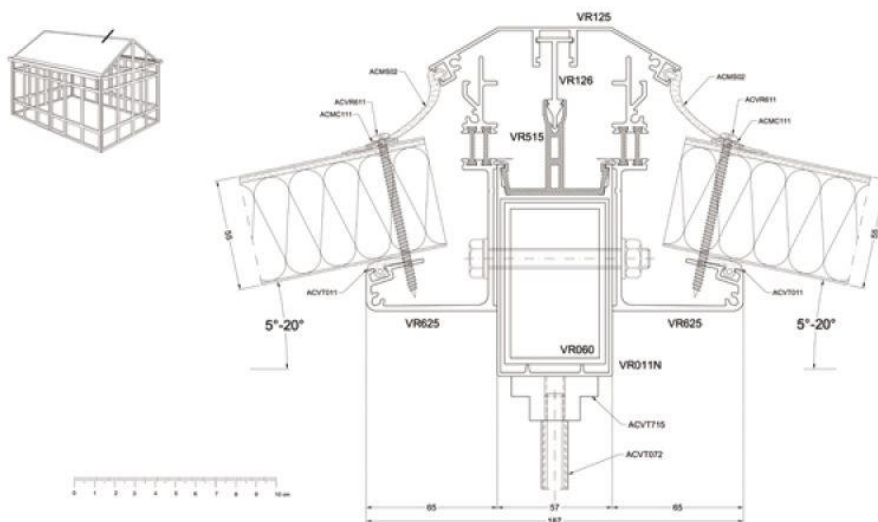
Detail hliníkovej konštrukcie – hrebeň, napojenie sklenených tabúl' na strešné priečniky, (Zdroj: www.pro-fil.pl, 2018)
